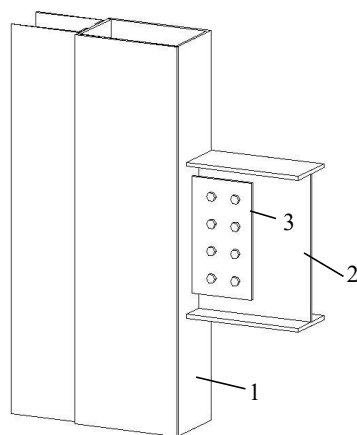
钢管混凝土边缘构件与钢梁铰接连接节点
